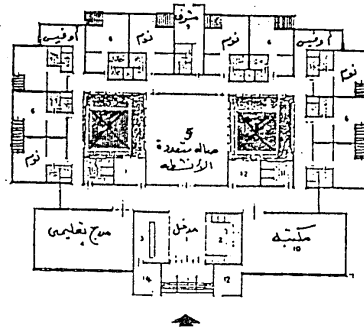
مسقط أفقي لوحدات فندقية مجمعه بمركز تأهيل مهني
